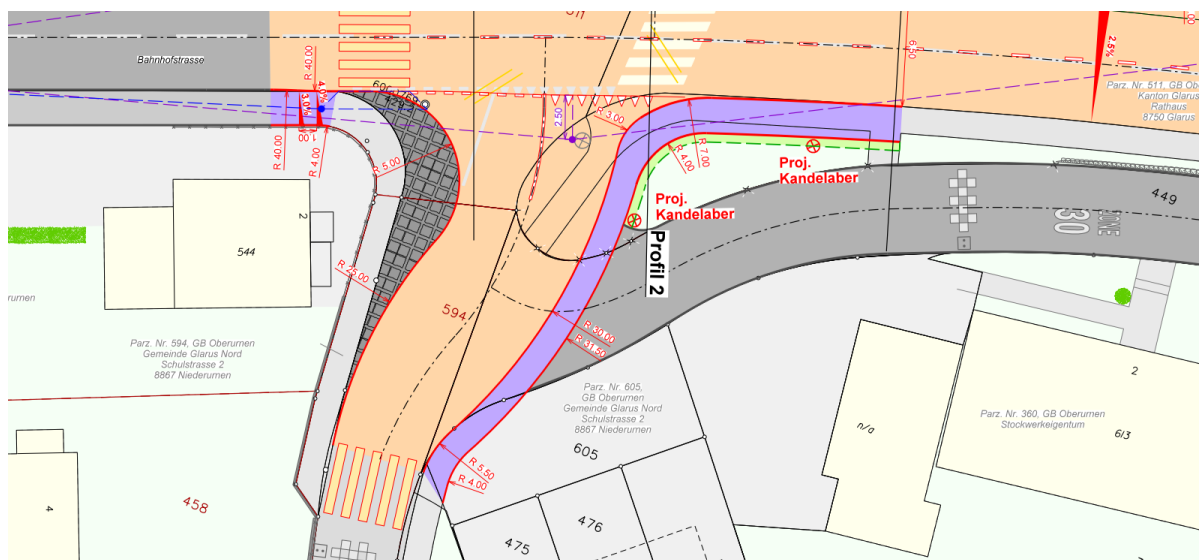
Situationsplan Ausschnitt Gehweg Kärpfstrasse-Fleichenstrasse
